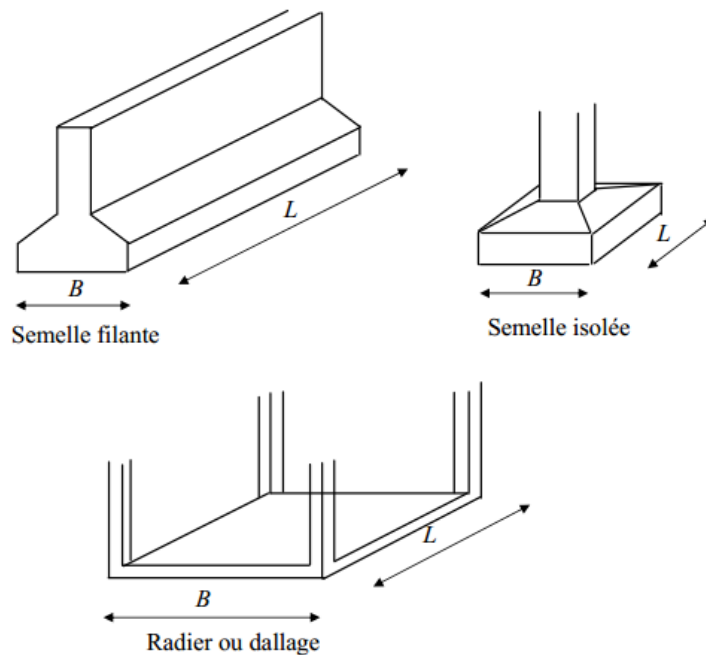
Types de fondations superficielles (Frank, 1999).
